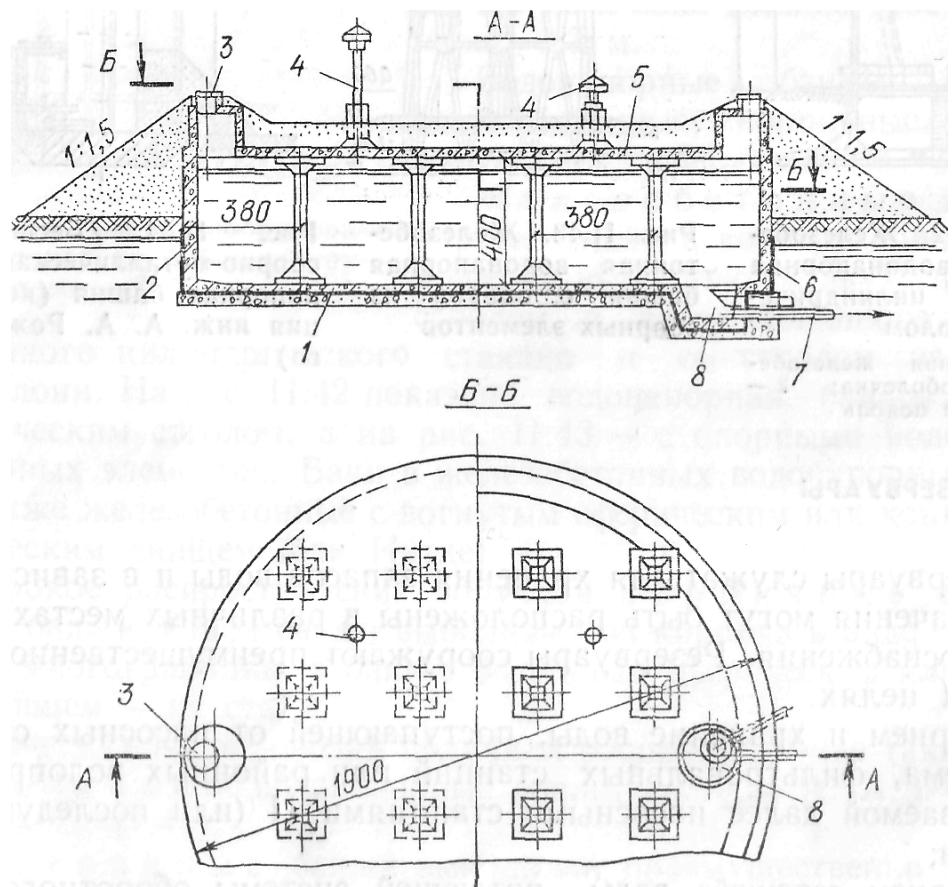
Железобетонный резервуар объемом 1000 м³, выполняемый в мокрых грунтах
